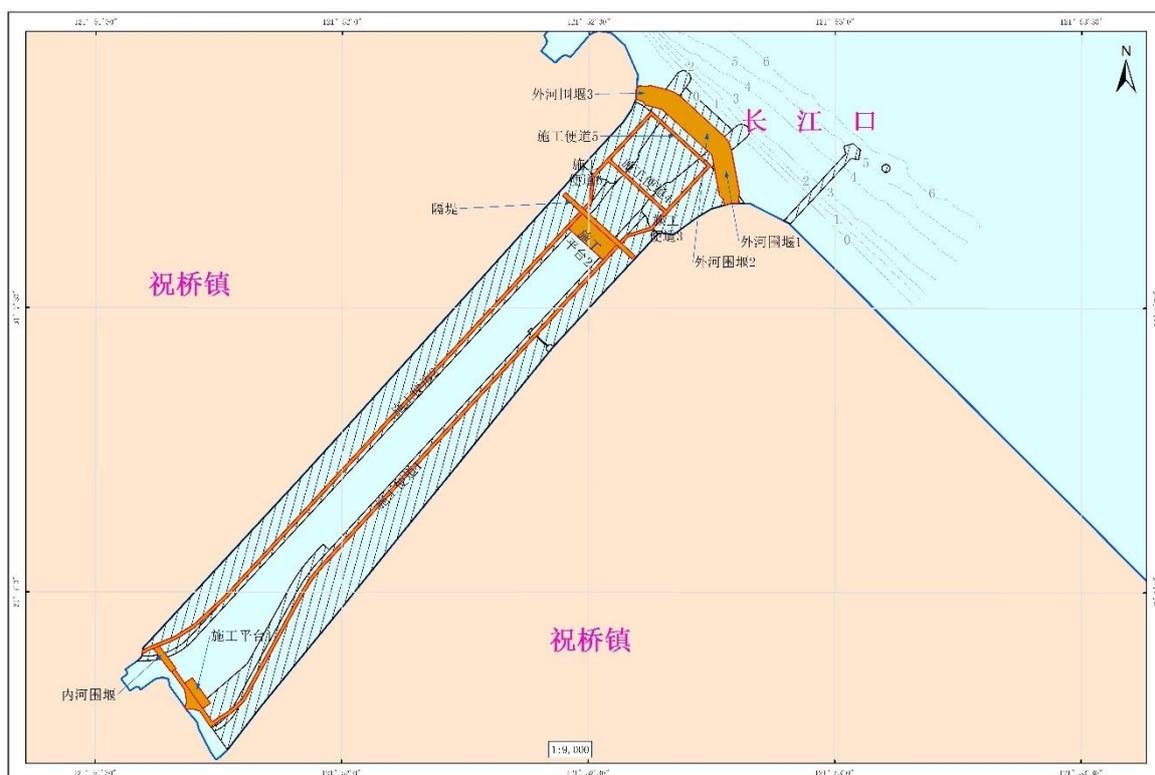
已批复宗海平面布置图（施工配合设施）
